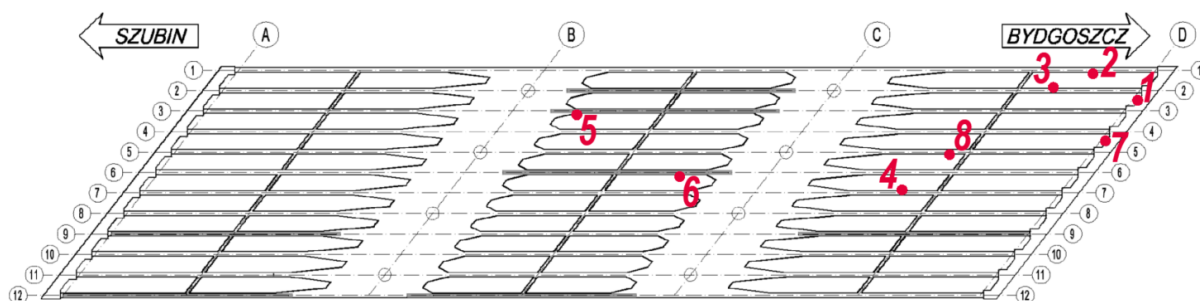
Widok ogólny miejsca przeprowadzonych badań
